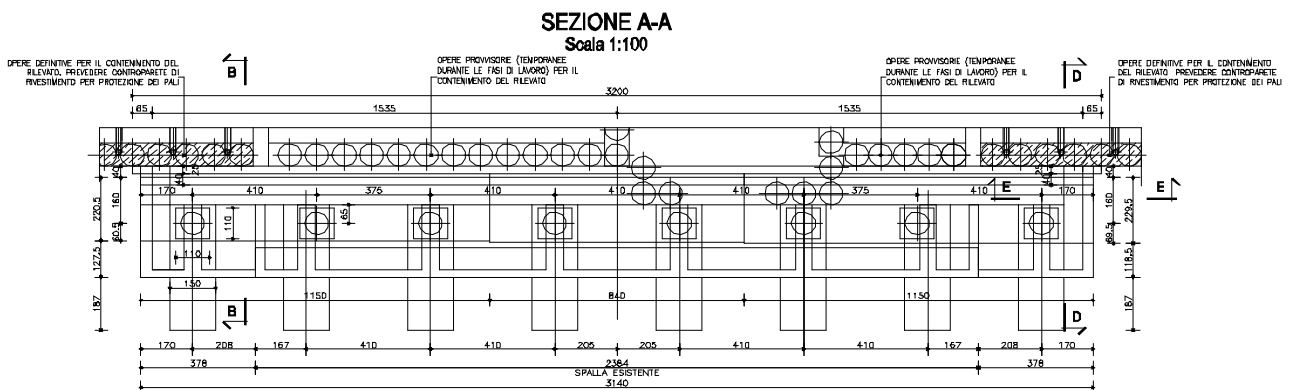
Realizzazione intervento su spalla (spalla lato BS)
